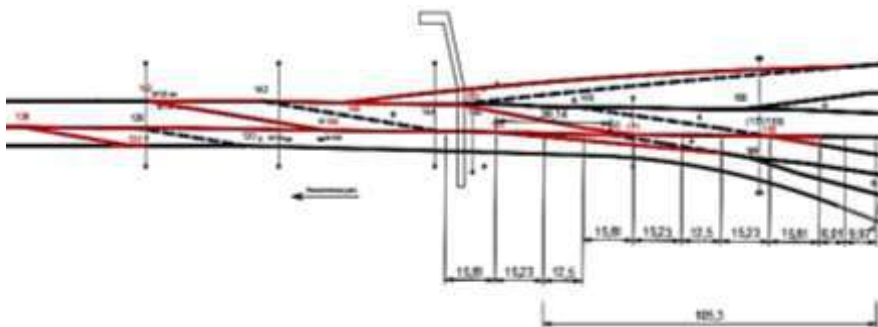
Схема смещения стрелочных переводов № 150, № 146, № 144, № 142, № 130, № 128 после укладки стрелочных переводов № 171 и № 158 взамен перекрестного стрелочного перевода
